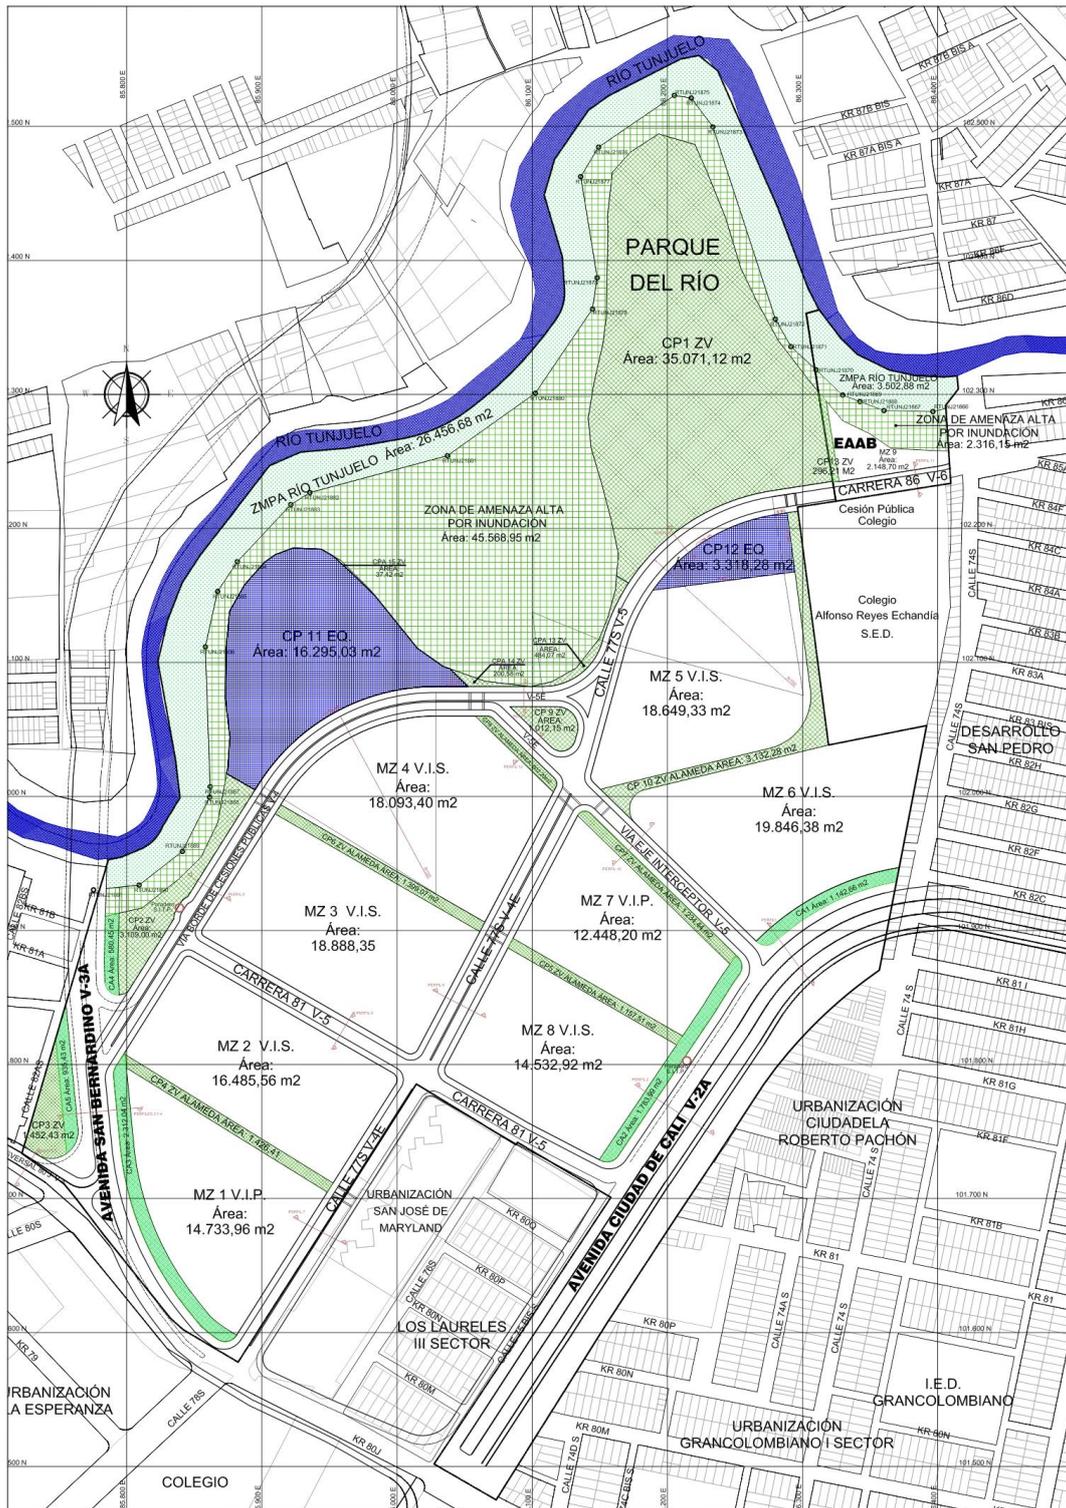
Planteamiento Urbano del Plan Parcial
